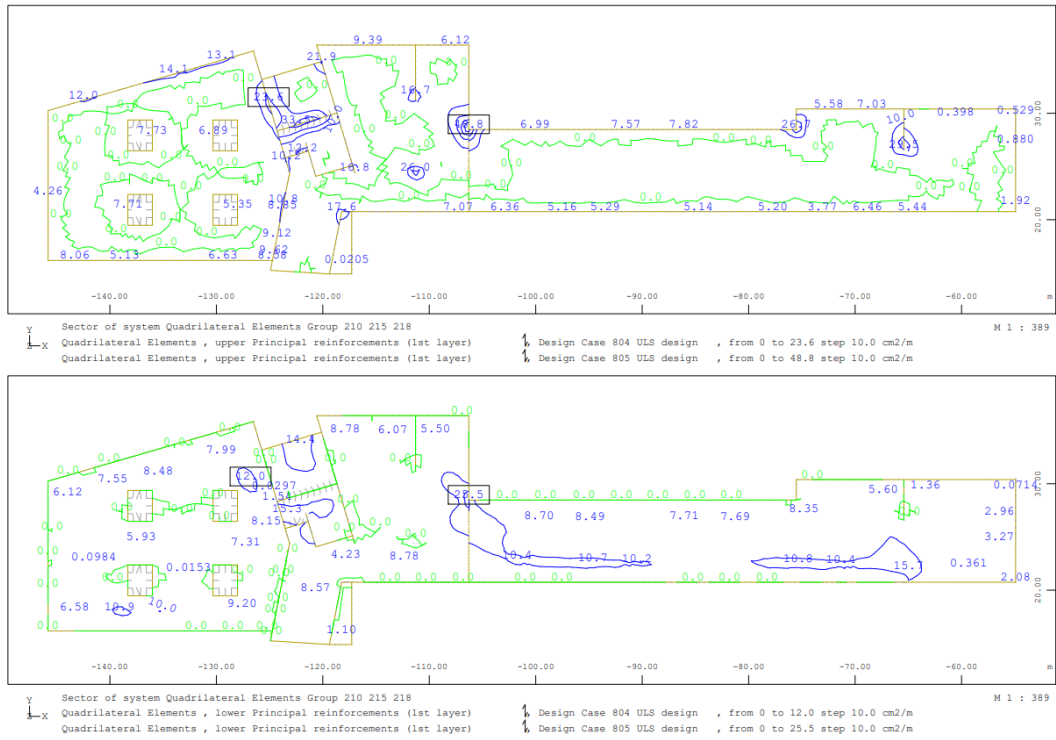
Armadura principal na face inferior (sup.) e superior (inf.) – laje de fundação – acesso Norte - ELU
